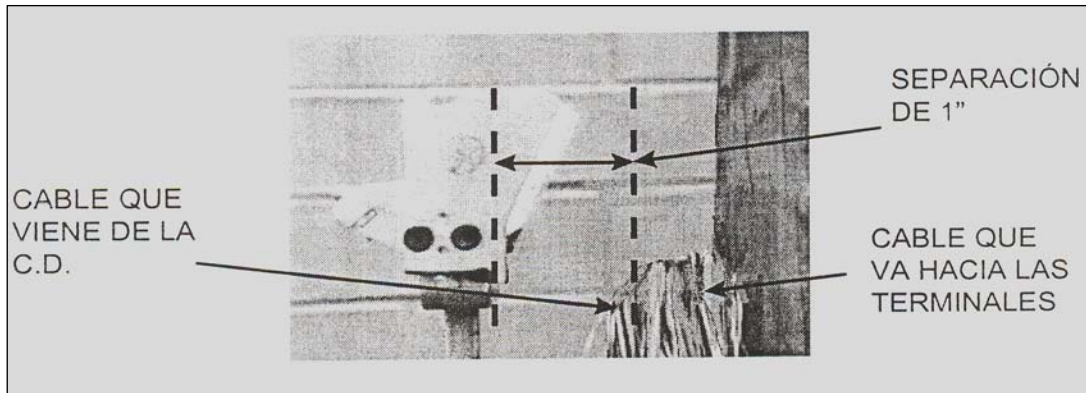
Separación del Cabezal y los Cables Para Empalme en Poste con Cierre Tipo Domo.
